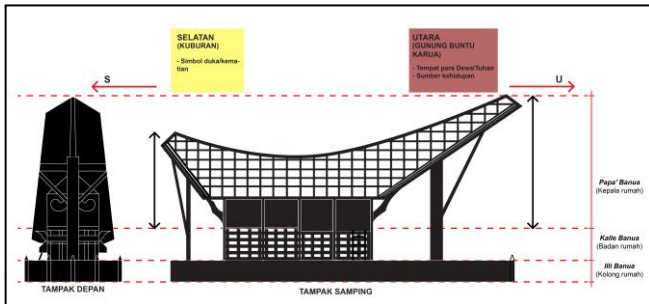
Potongan Site Banua Sura di Tondok Sirenden
